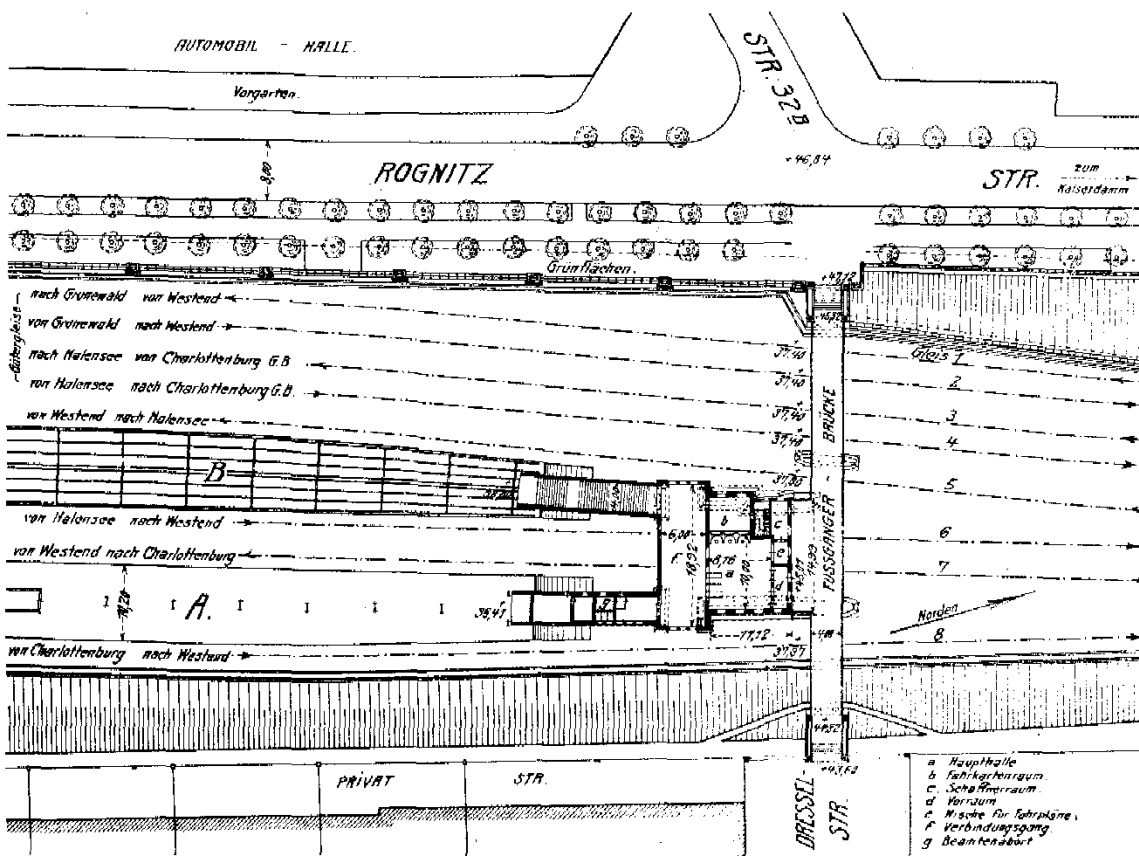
Lageplan des Fahrkartengebäudes an dem Fußgängersteg zwischen Dresselstraße und Rognitzstraße.
